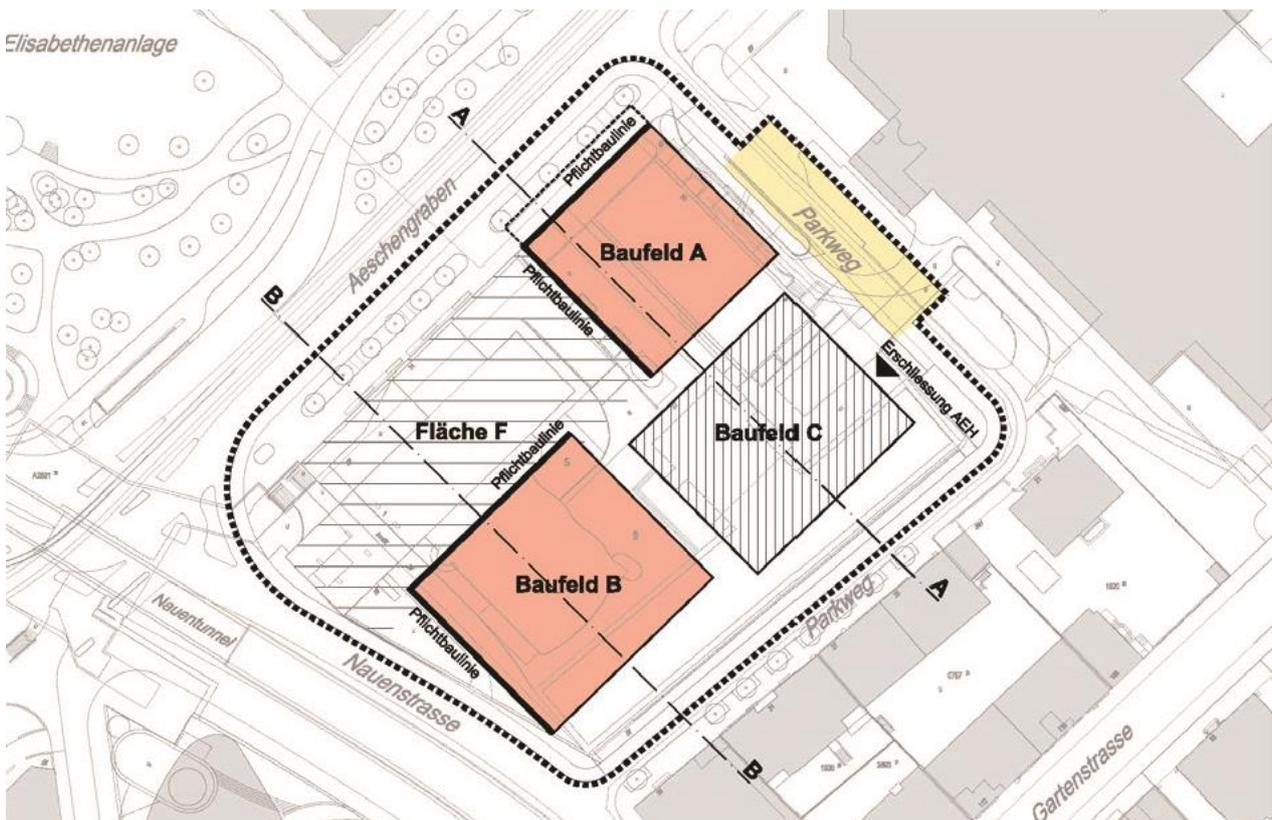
Bebauungsplan Nr. 13'702 Areal Aeschengraben, Situation mit Platzfläche F und Teilbereich Parkweg (Norden oben, ohne Mst.)
